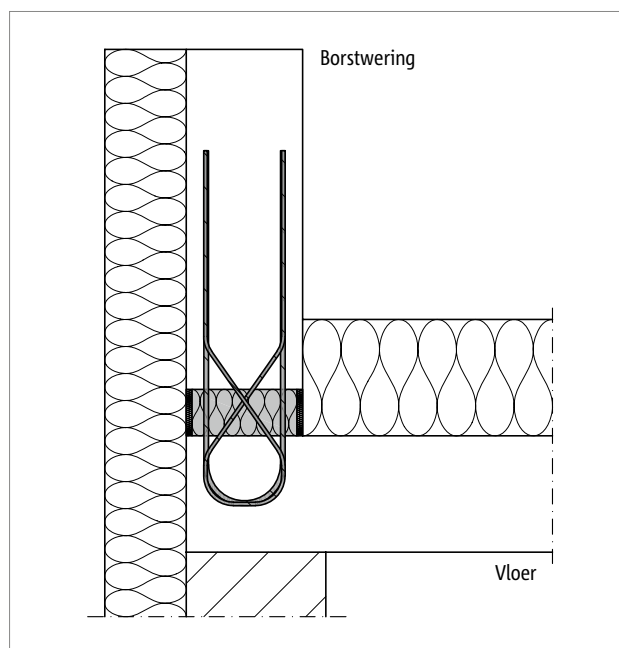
Schöck Isokorb® T type A verticale toepassing: Zijaanzicht borstwering opgeplaatst
